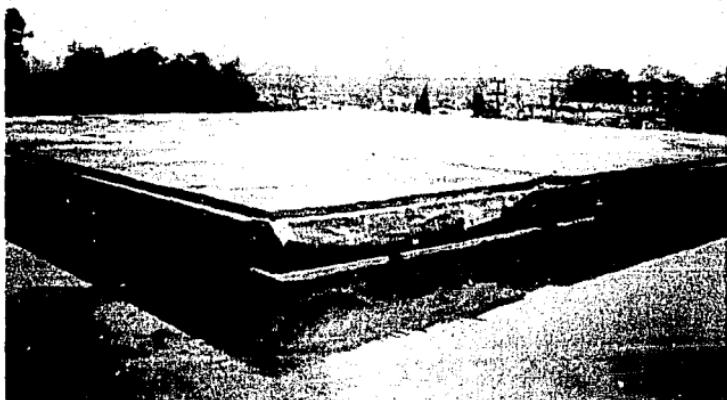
Losas de 8 cm coladas para los dos niveles (cubierta original)
